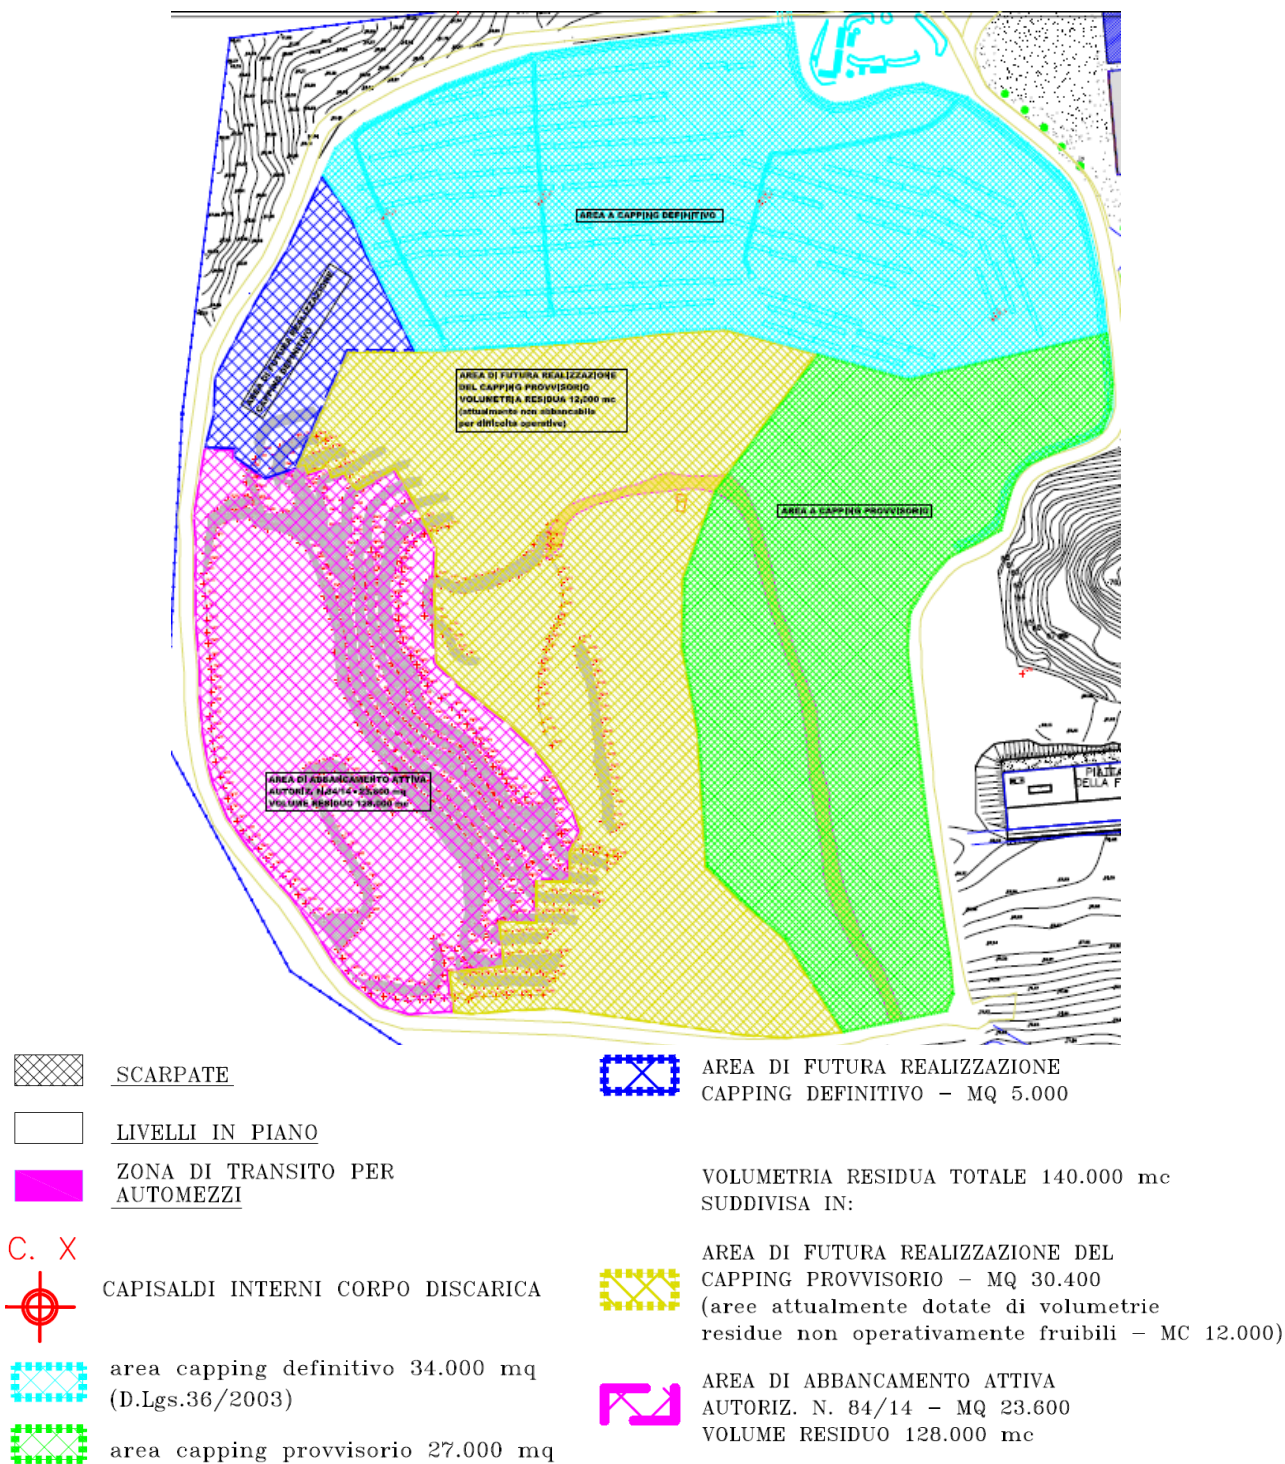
Planimetria della Discarica (rilievo Ottobre 2015)
